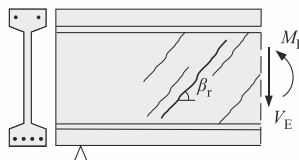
Querkraftrissbildung bei profilierten Betonbauteilen
